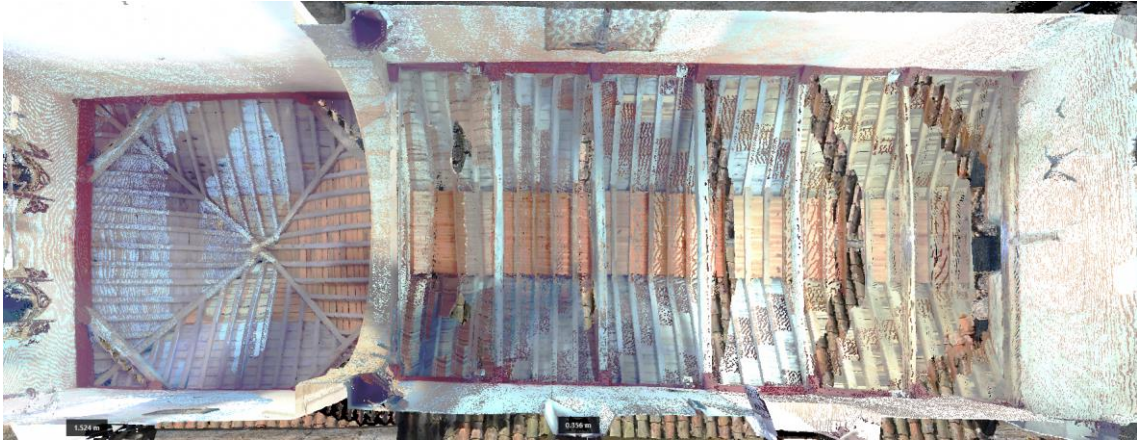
Estructura de madera de las cubiertas de capilla y nave, vista desde abajo. Fuente: Elaboración propia.
